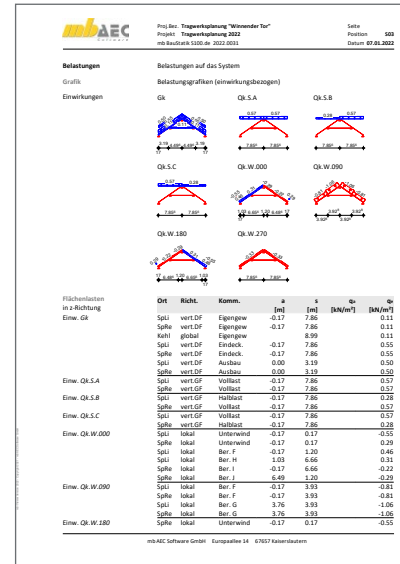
Ausgabe Belastungen „S100.de“ - BauStatik
